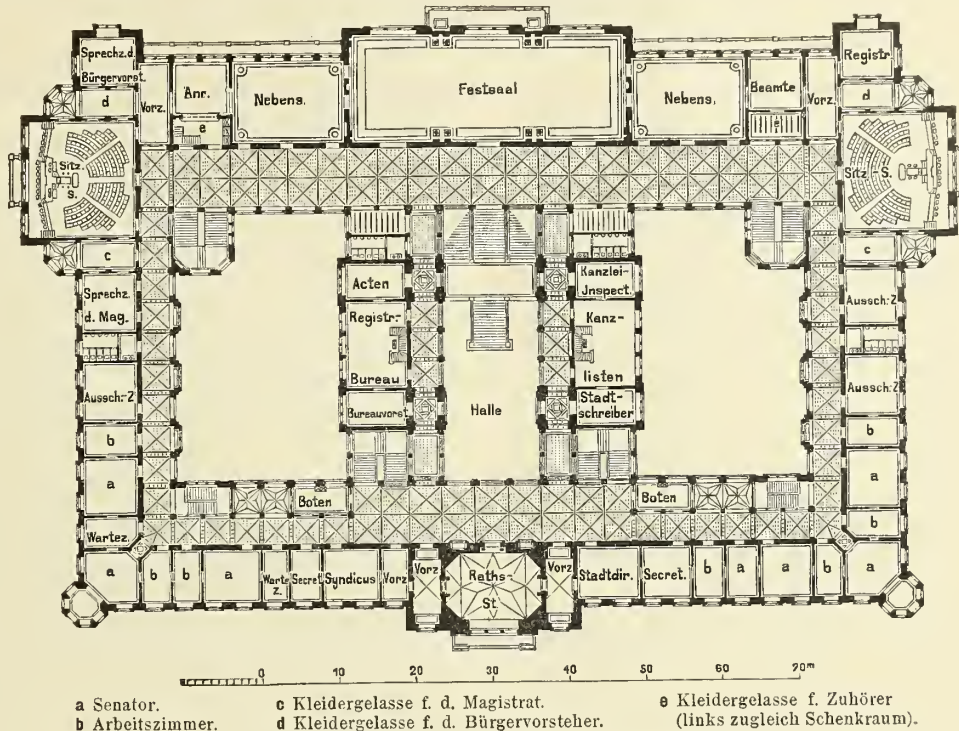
Grundriss vom 1. Obergeschoß.
